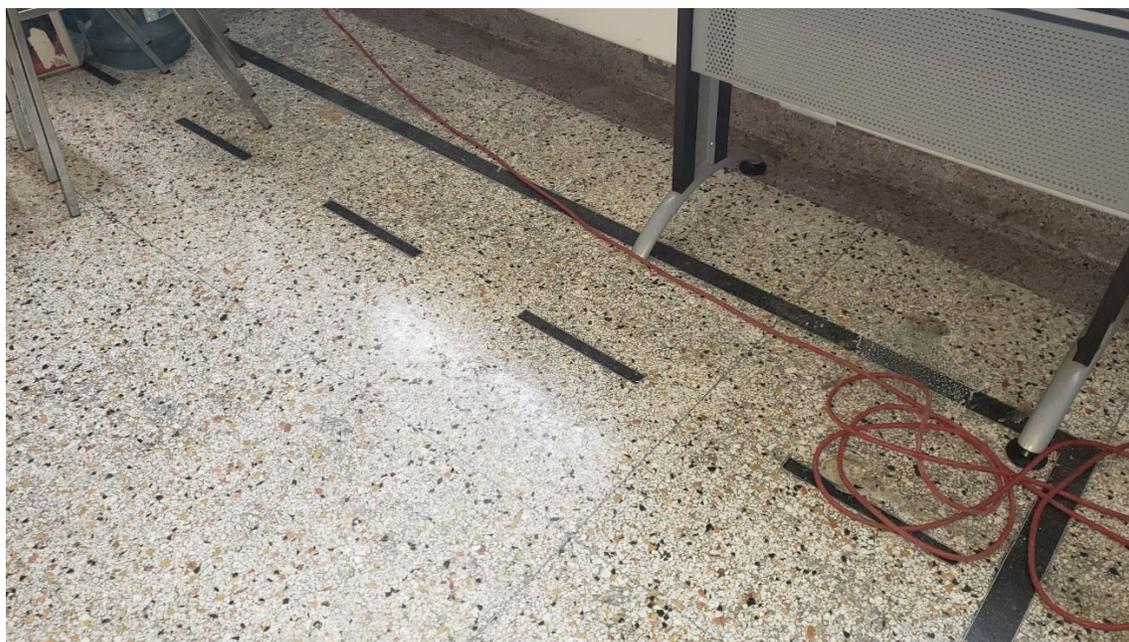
Observation d'eau sur le plancher du gymnase (rez-de-chaussée)
